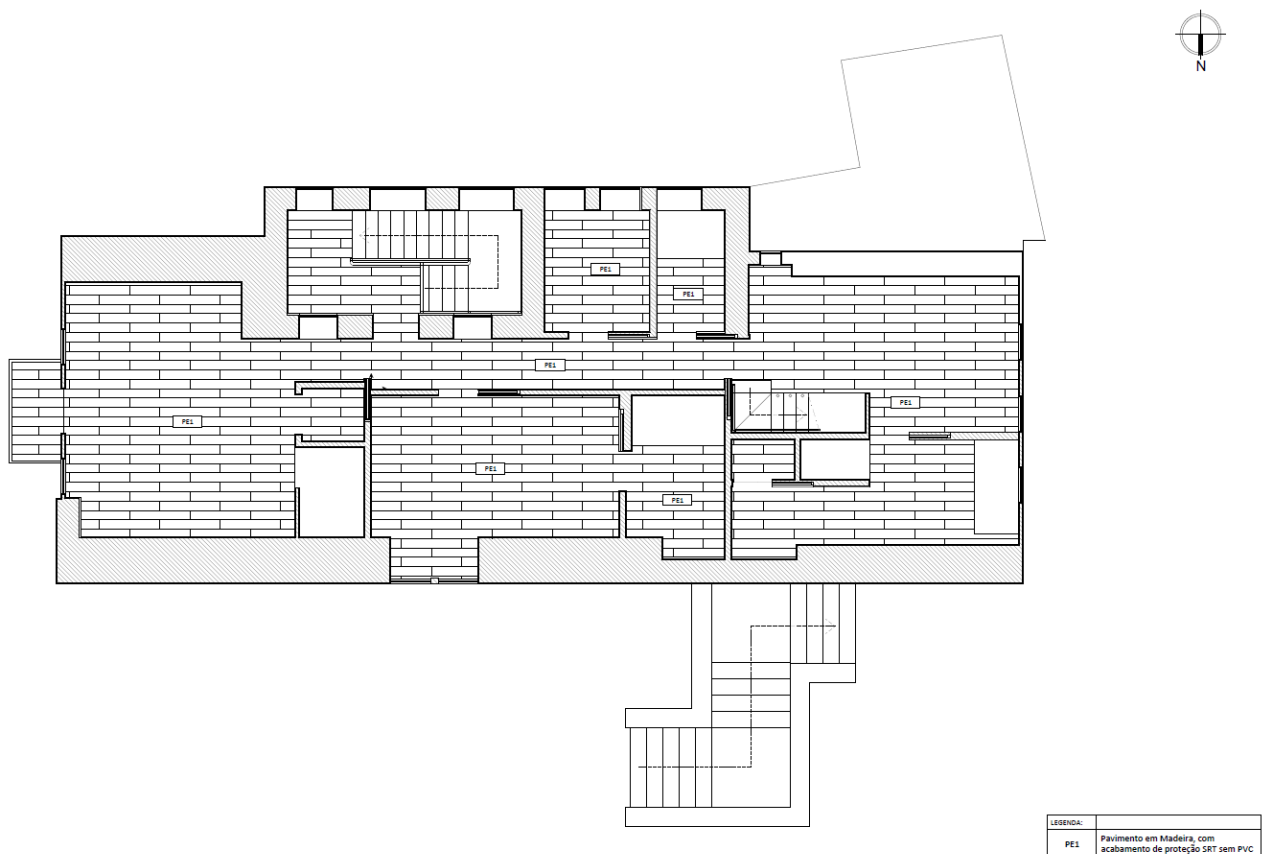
Planta de Pavimento, Alojamento Loureiro, Piso 1.
